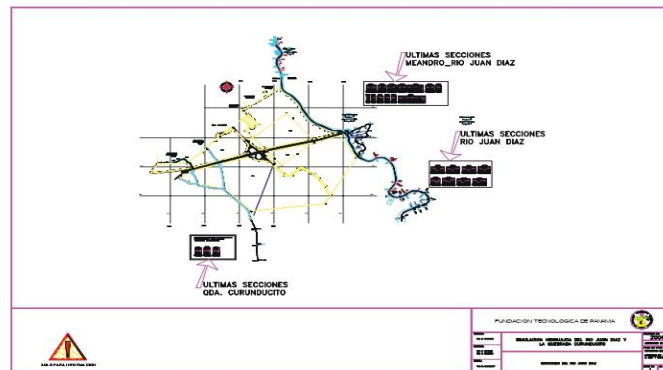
Ubicación de las secciones levantadas y área a desarrollar.
